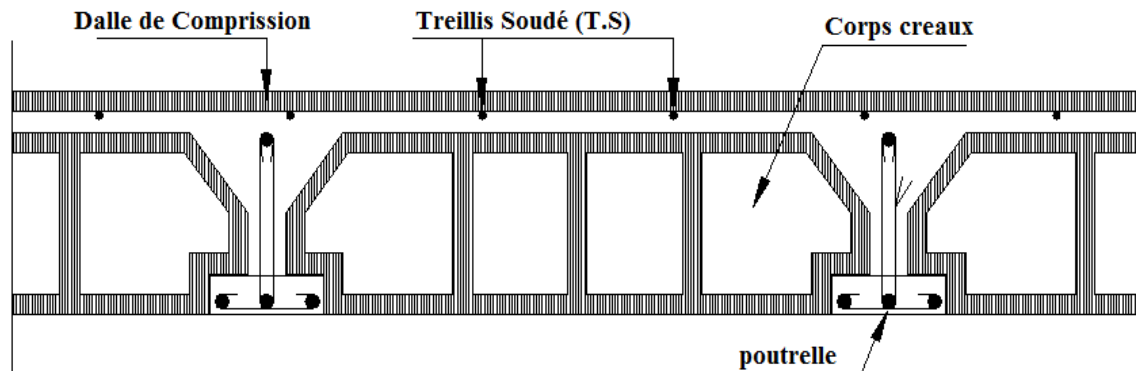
Coupe verticale d'un plancher en corps creux
